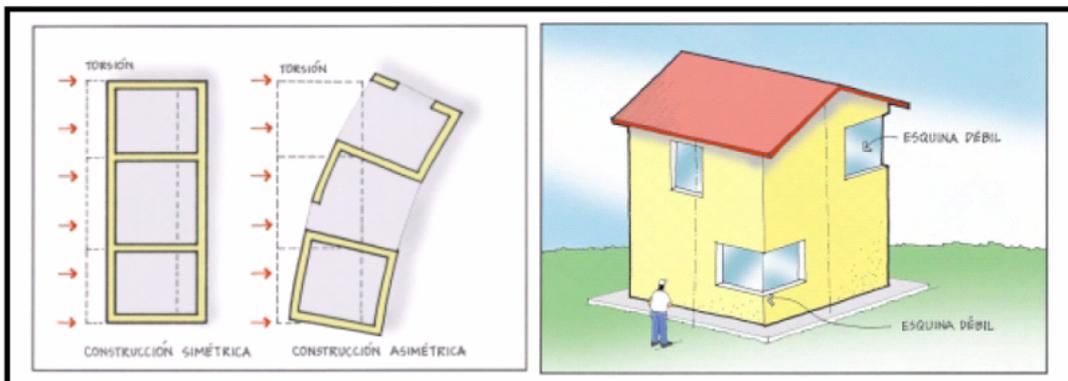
Concepto de regularidad en planta. Fuente AIS
